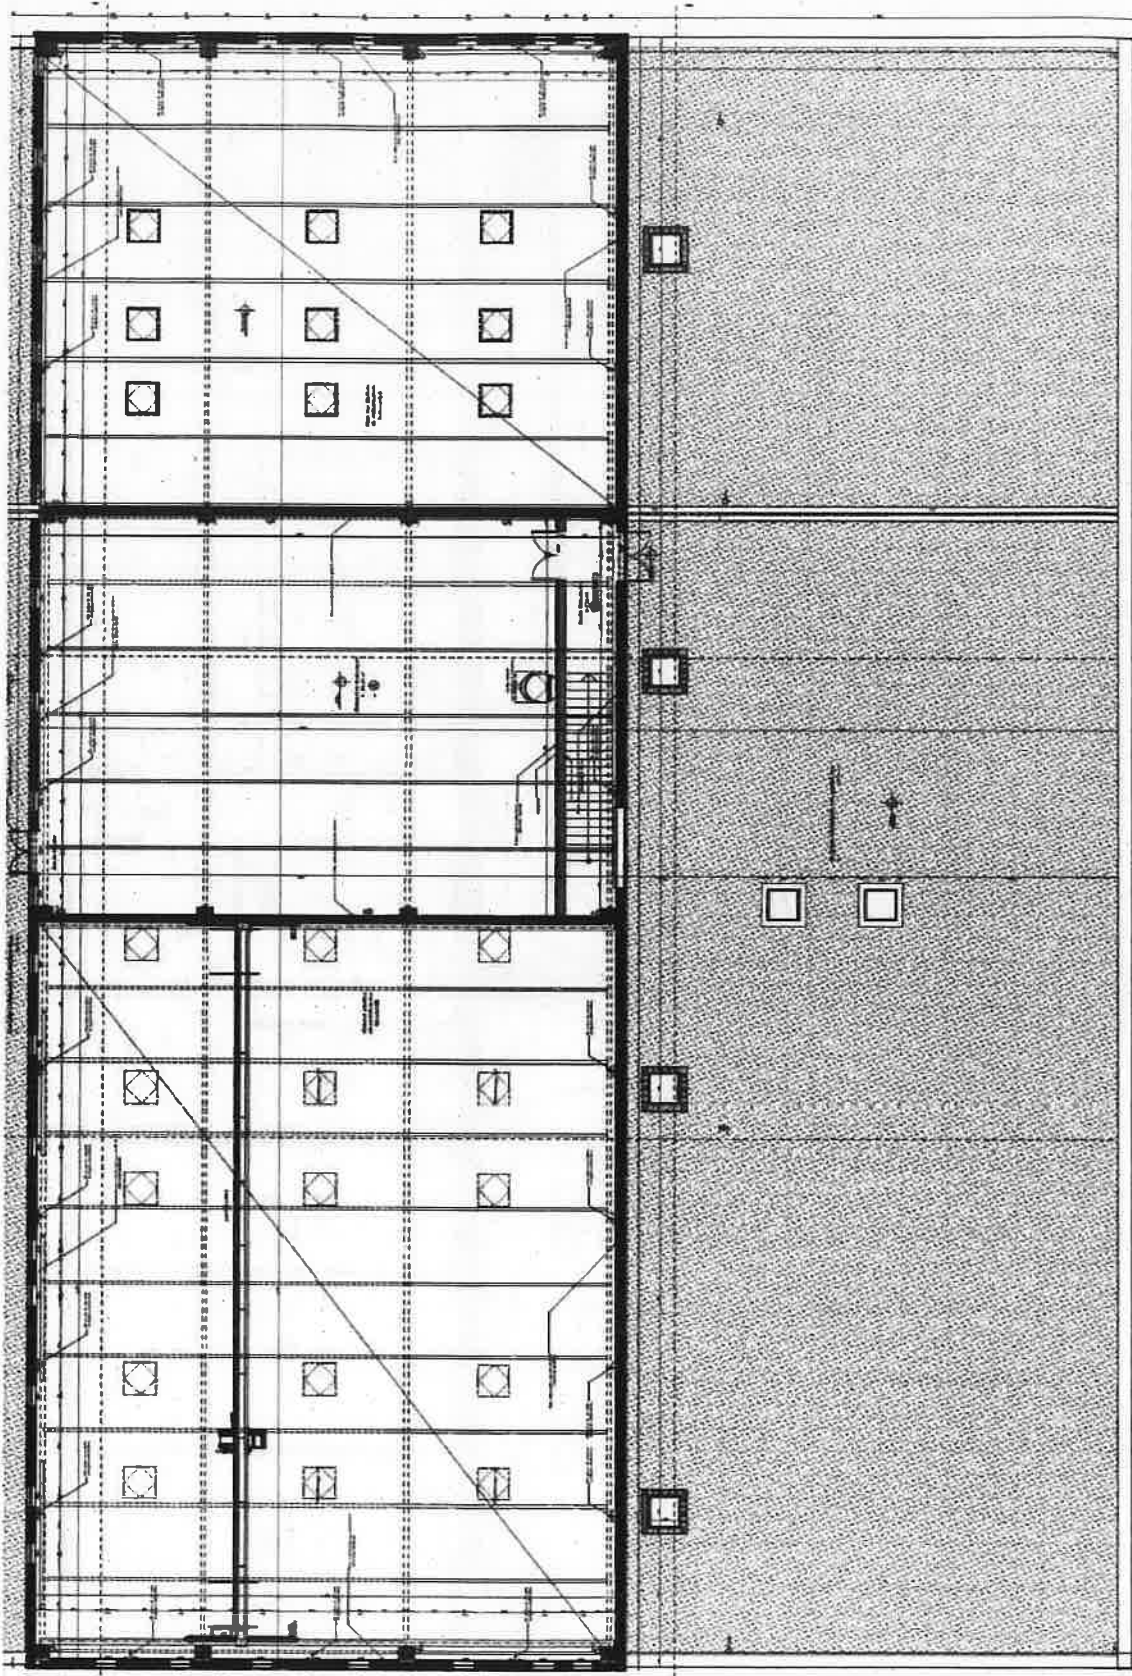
Plan de masse du 1^{er} étage du bâtiment projeté NT12 (source : 3^e RMAT, réalisation : cabinet d'architecte BPM)
